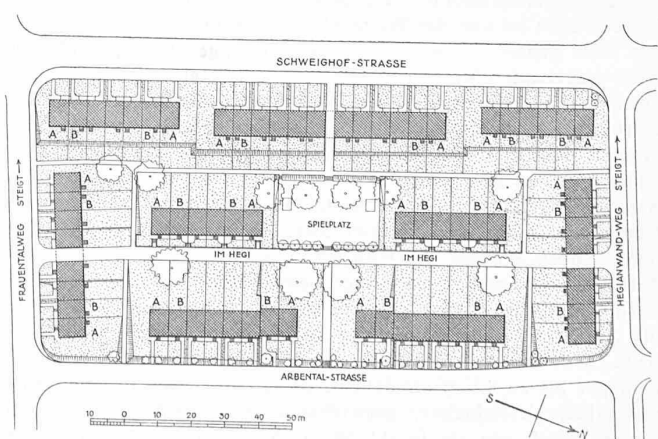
Lageplan der Kolonie Schweighof. — Masstab 1 : 2000.
